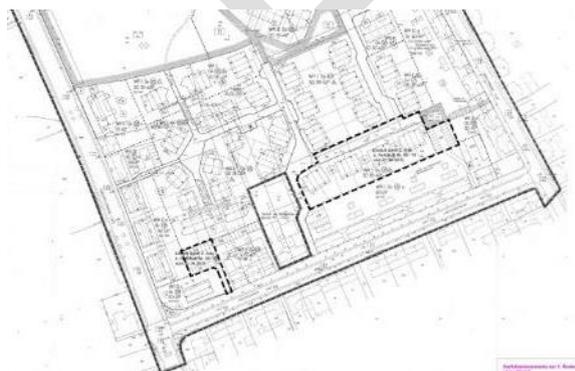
Bebauungsplan Nr. 75/1a, 1. Änderung, Blatt 2
